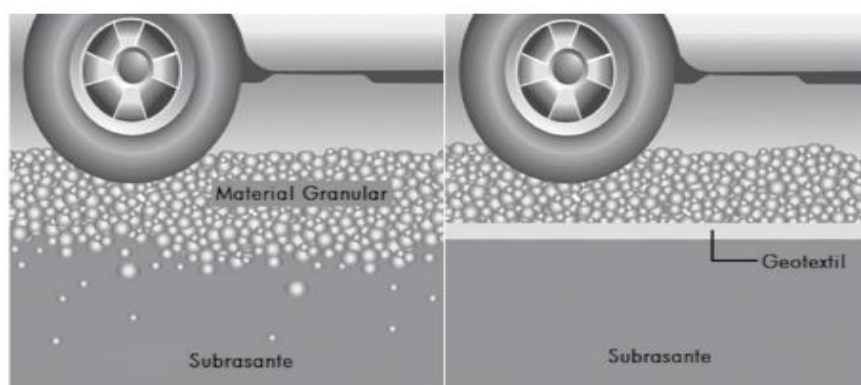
Se muestra cómo se coloca el geotextil no tejido en caminos (uso de geotextiles en el drenaje subsuperficial o subdrenaje, aplicación de geotextiles no tejidos en caminos, 2014).
